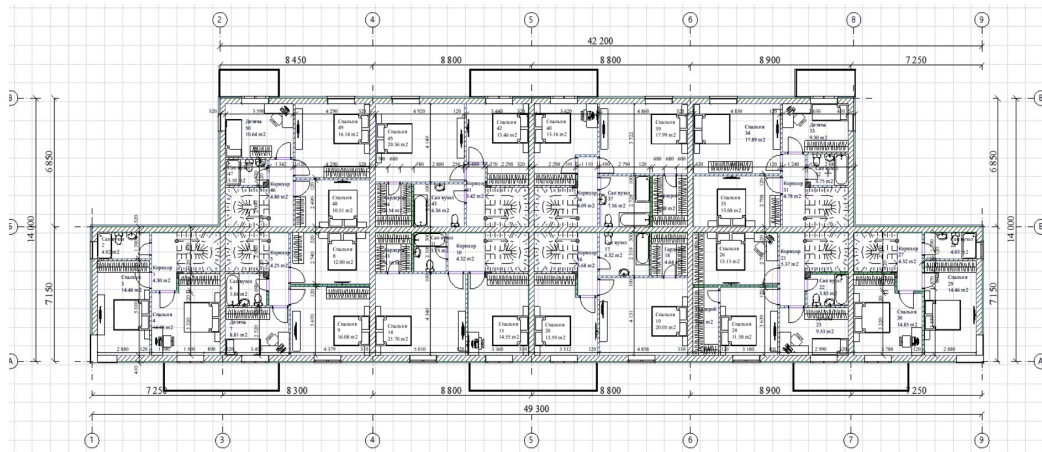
Блокований десяти квартирний двоповерховий мансардний житловий будинок. План другого поверху: хол зі сходами; вітальня спальня); вітальня спальня); гардероб; SW (ванна, туалет); балкон.
